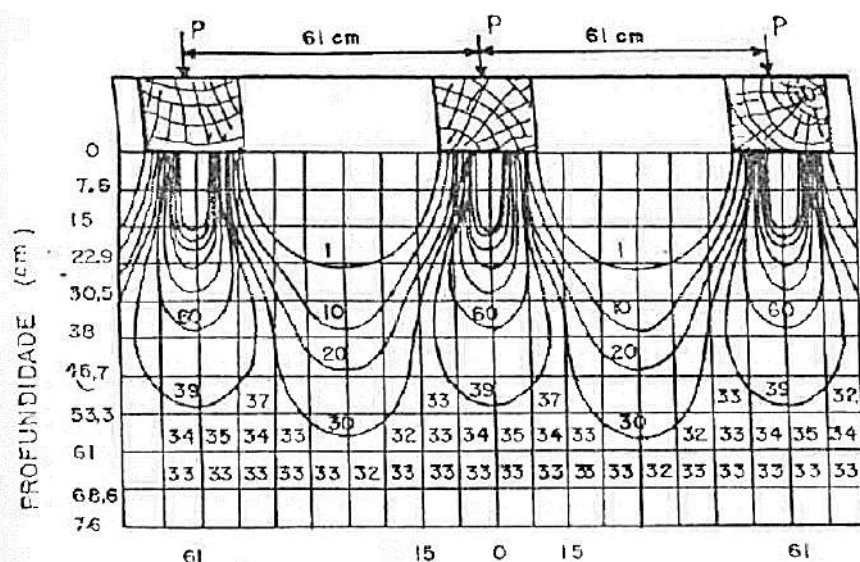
Bulbos de tensões verticais com 3 dormentes espaçados em 61 cm
